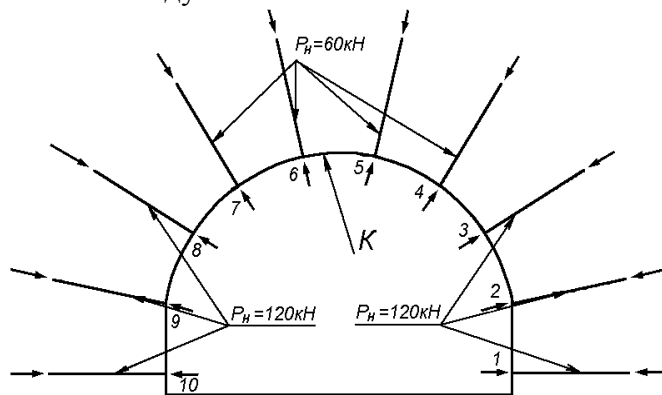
Усовершенствованный способ опорно-анкерного крепления выработки, предупреждается образование зон разрушения пород на ее контуре.
